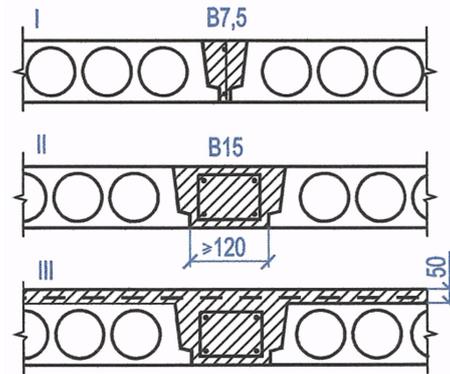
Типы перекрытий из сборных железобетонных плит
